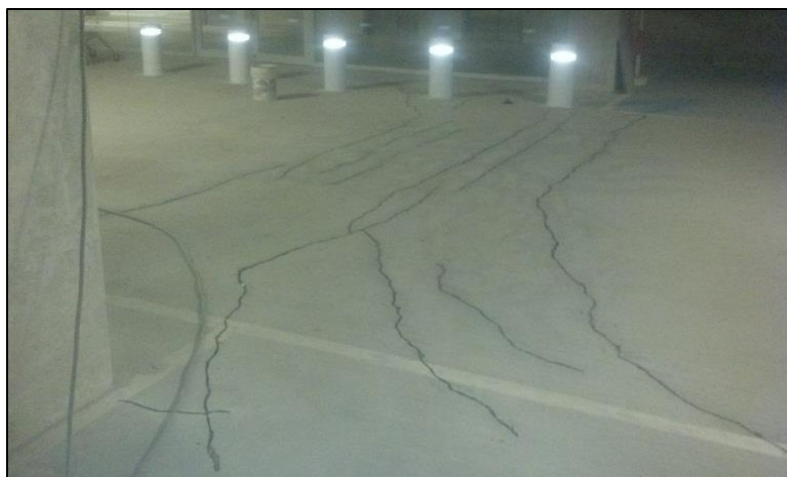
Fisuras y grietas en losas macizas del estacionamiento.
